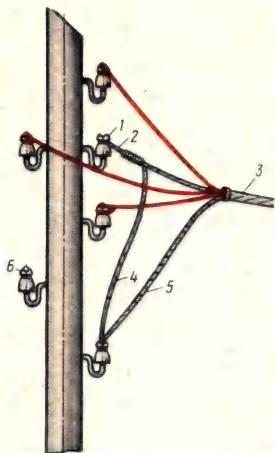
Четырехпроводное ответвление от ВЛ проводом с несущим тросом: 1 — дополнительный изолятор; 2 — трос; 3 — провода ответвления; 4 — зануление троса; 5 — нулевая жила; 6 — изолятор для провода наружного освещения
